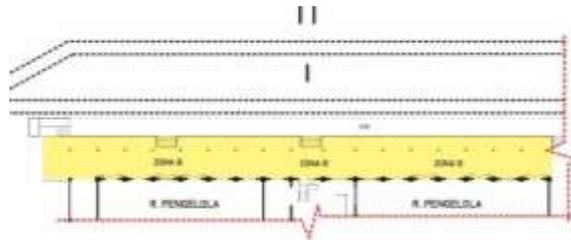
Denah Ruang Tunggu Keberangkatan Stasiun Kereta Api Binjai (Sumber: Penulis, 2021)
